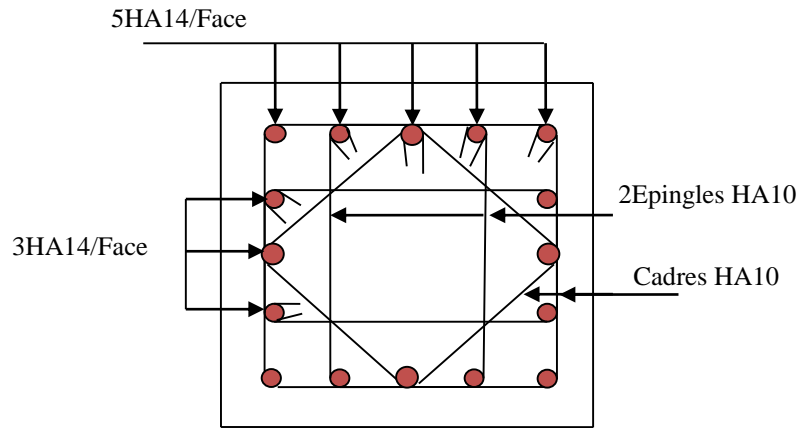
Schéma de principe de ferrailage et réduction des sections des poteaux
